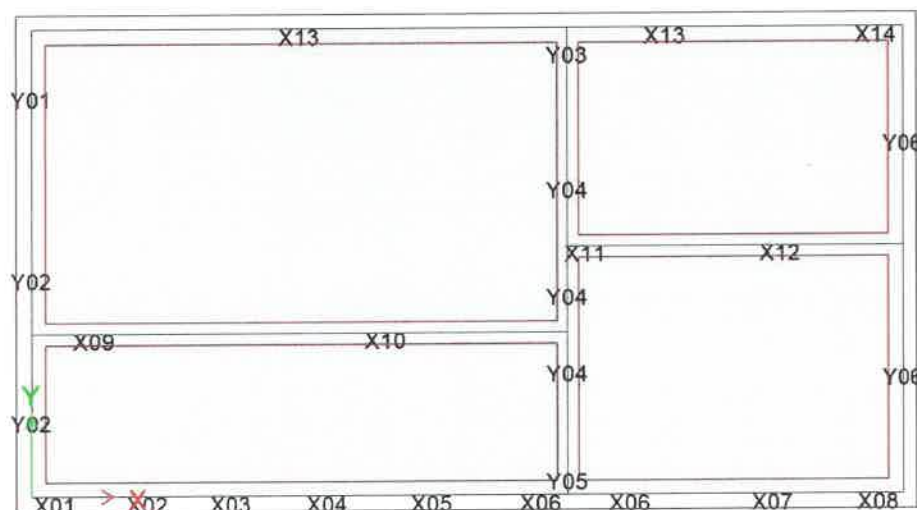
Vedere în plan spaleti din zidarie (parter)
